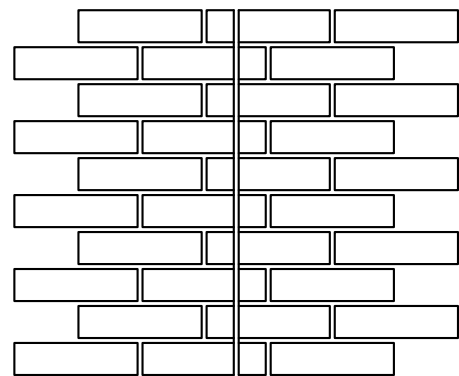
Vista de la fachada en el lugar de las juntas de dilatación.
